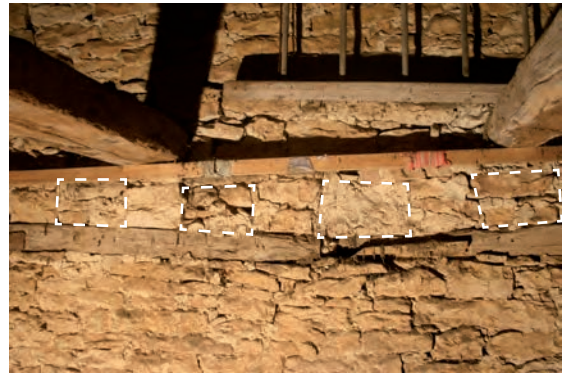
Empochements de poutre du plancher du 4^e niveau, comblés (salle 7, mur sud)
